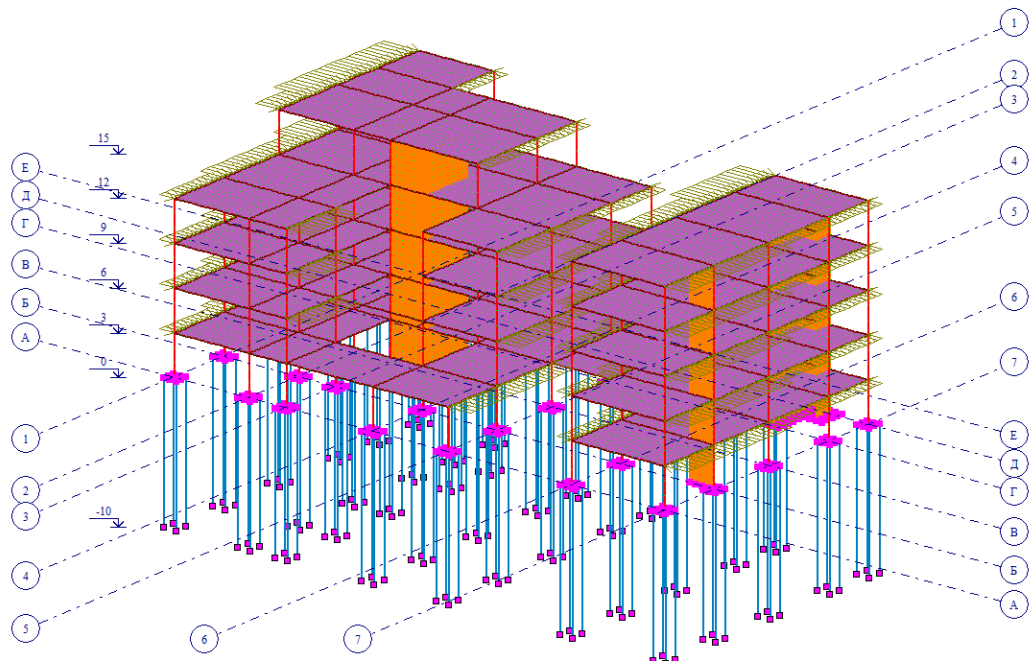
Расчетная модель здания в ПК ЛИРА САПР
